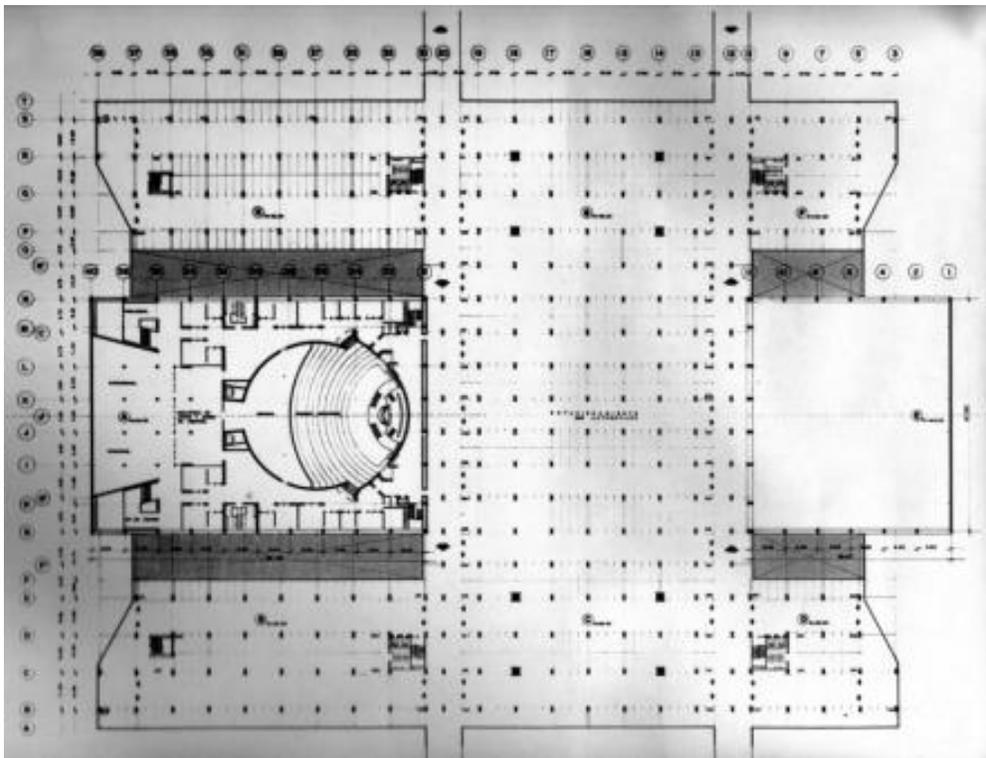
Planta de Conjunto. Fuente: Archivo PR.
